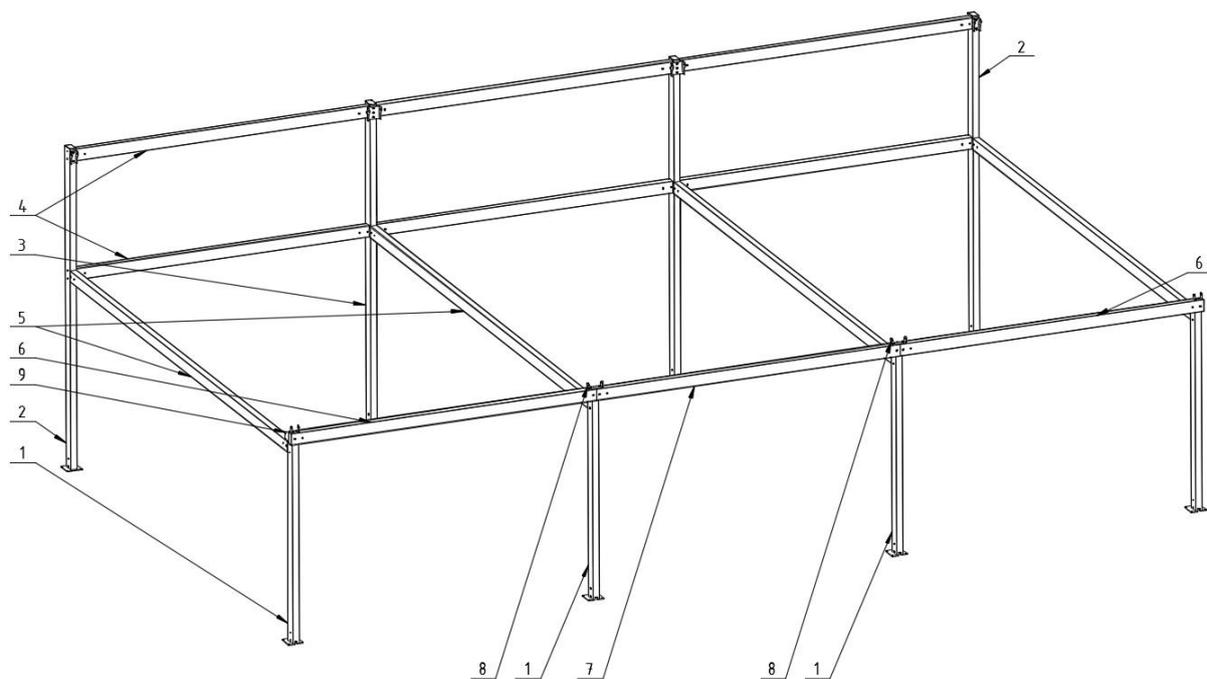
Structure porteuse version modulaire : 1 - Poteau bas, 2 - Poteau haut (droite, gauche), 3 - Poteau haut (intermédiaire), 4 - Poutre arrière, 5 - Poutre latérale, 6 - Poutre avant (droite, gauche), 7 - Poutre avant (intermédiaire), 8 Support de poutre de guidage modulaire, 9 - Gouttière.
